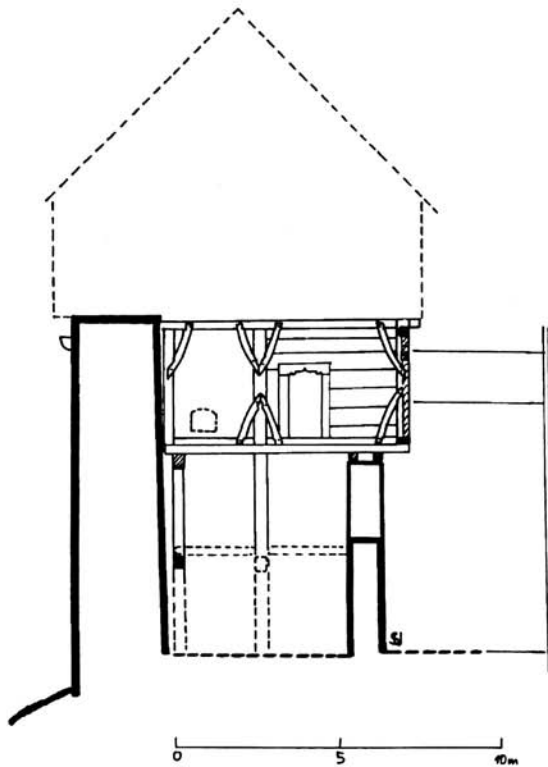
Wäscherschloß, Querschnitt durch den Wohnbau des 15. Jahrhunderts (Flurbereich mit Blick nach Norden), Rekonstruktion der ursprünglichen Gliederung mit zweigeschossigem Unterbau und auskragenden Fachwerkobergeschoss. Zeichnung: S. Uhl.
